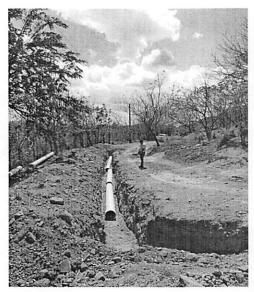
Colocación Tuberia Ø12" PVC SDR-26 1
